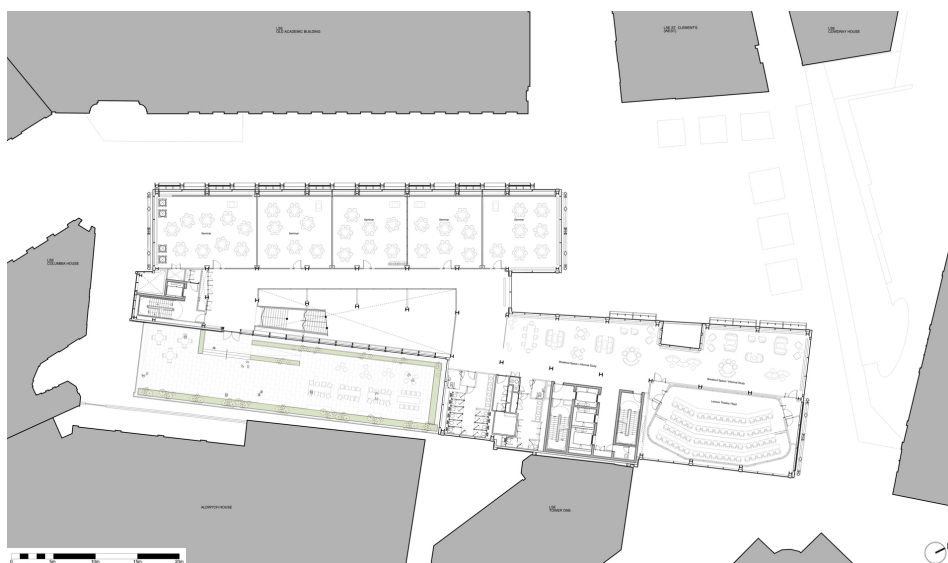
LSE Centre Building | Planta do 2  Pavimento
